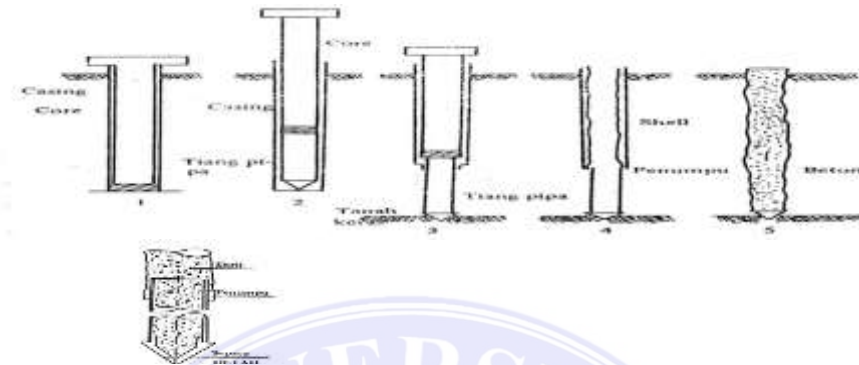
Tiang Pancang *Composite Ungaged-Concrete And Wood Pile* (Sardjono, 1991)
